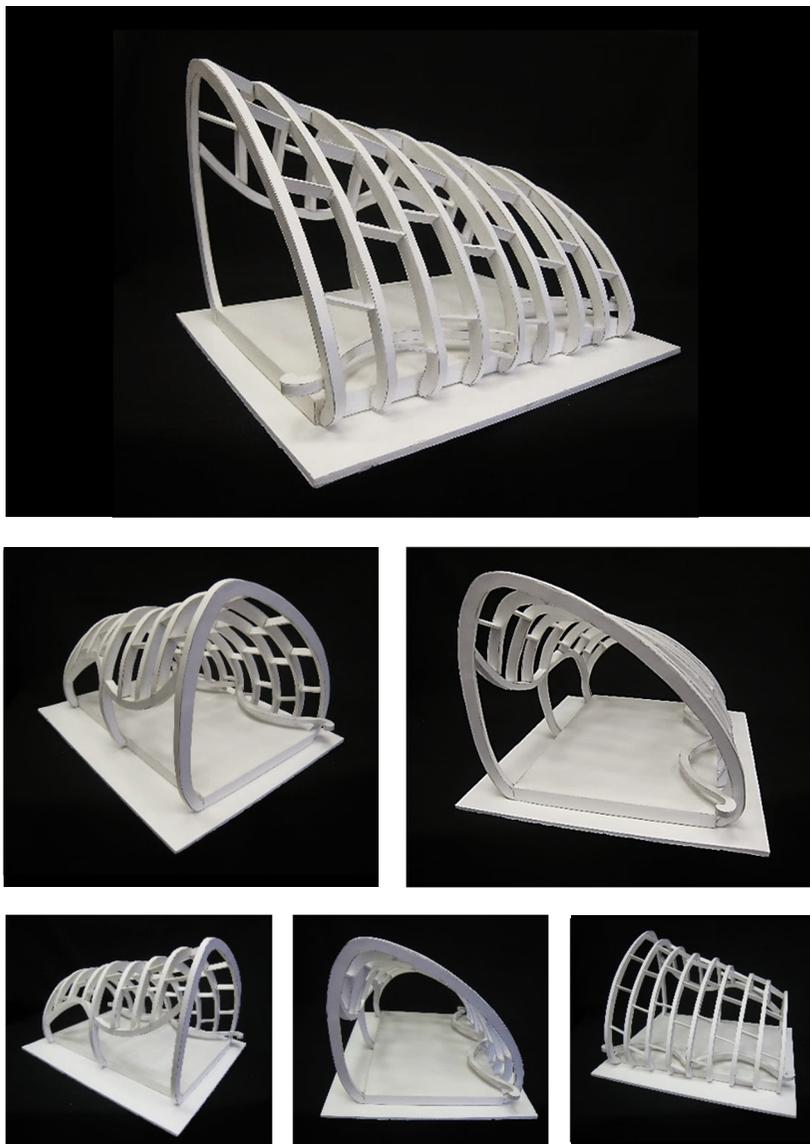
Теневой навес-беседка из клееных деревянных конструкций.
